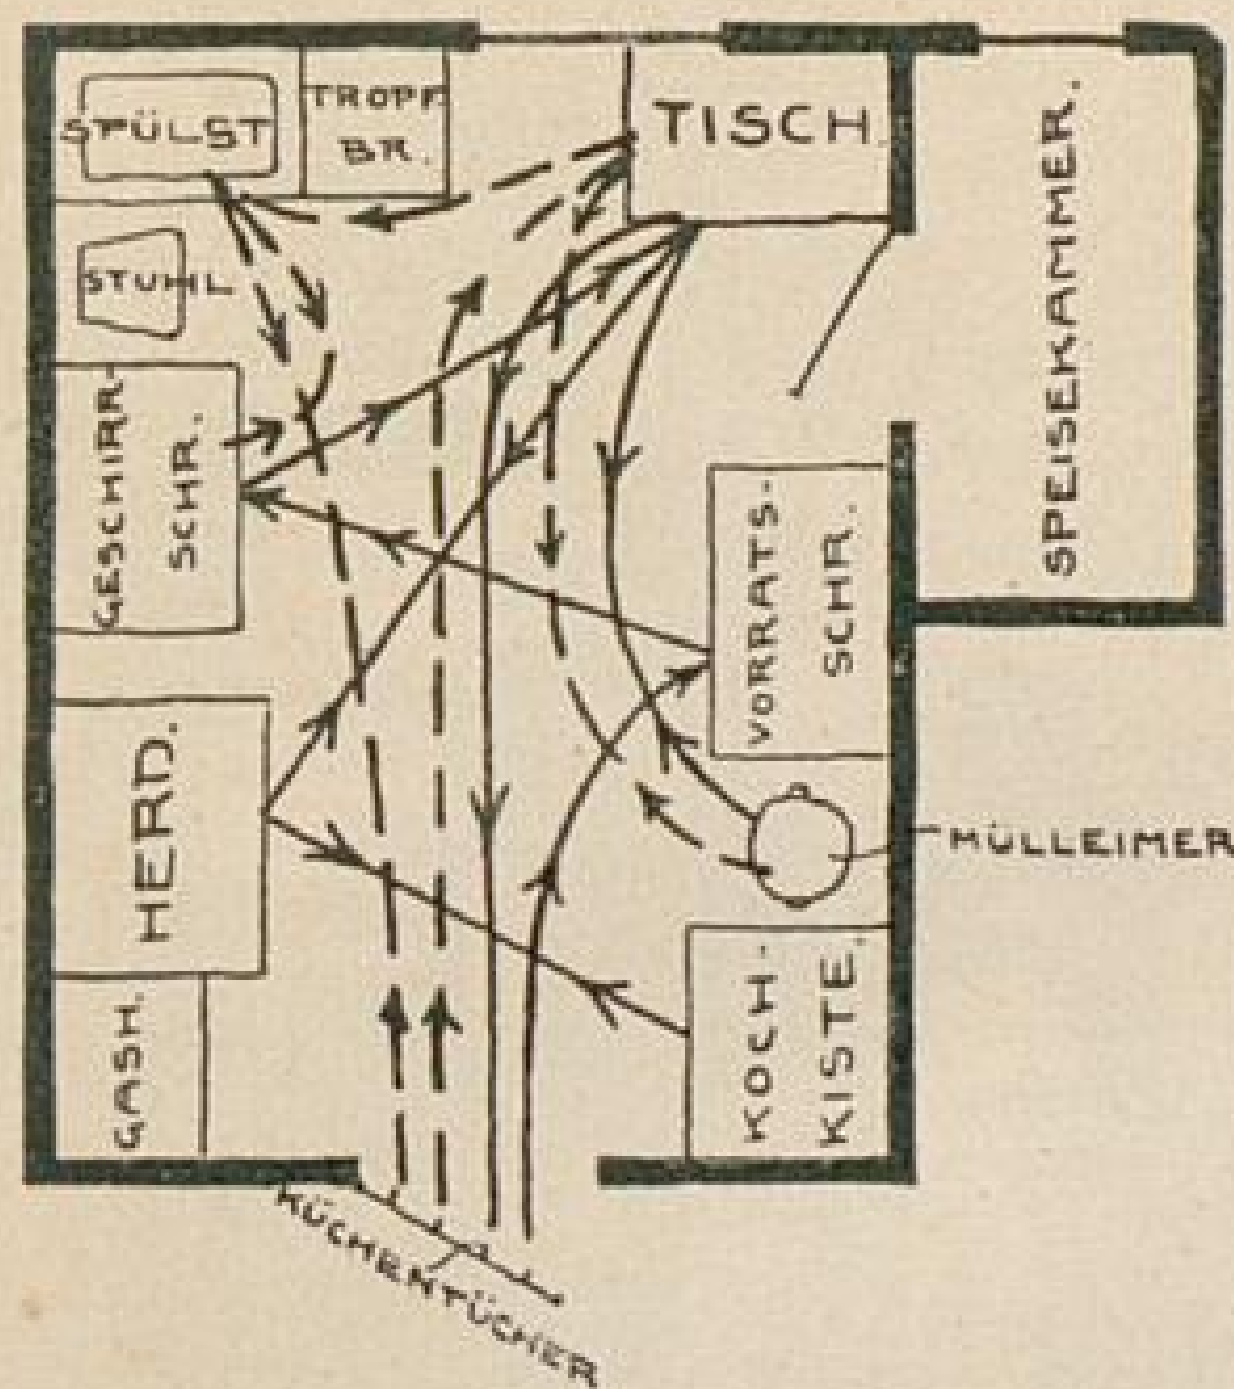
Grundriß der gleichen Küche mit schlechter Möbelaufstellung
